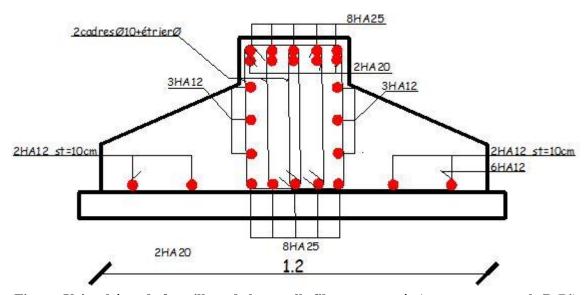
schéma de ferraillage de la semelle filante en travée (coupe transversale B-B').
